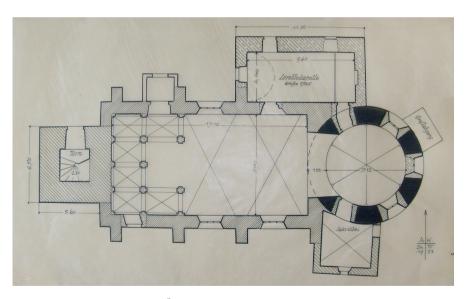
Pfarrkiche Murstetten, NÖ., Grundrissaufnahme (mit Baualter) von A. Klaar, 1953. BDA, Wien
